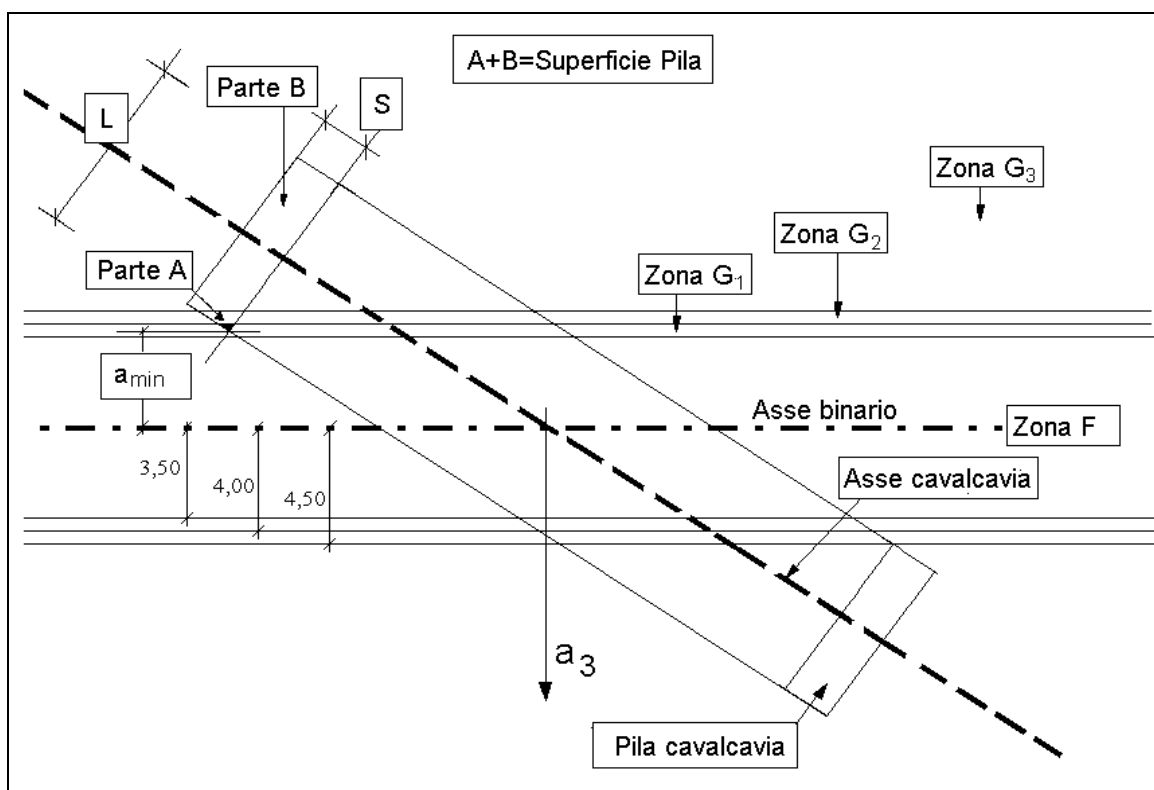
Zone di rispetto orizzontali
